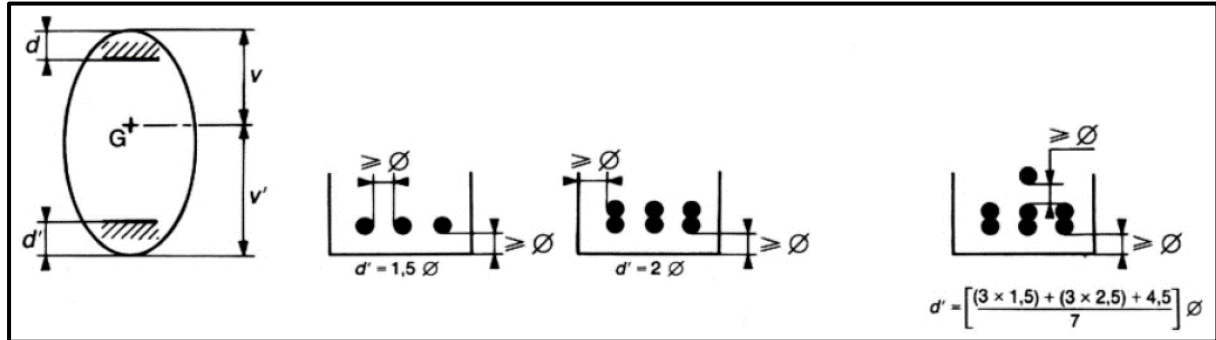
Dispositions constructives des câbles de précontrainte.
